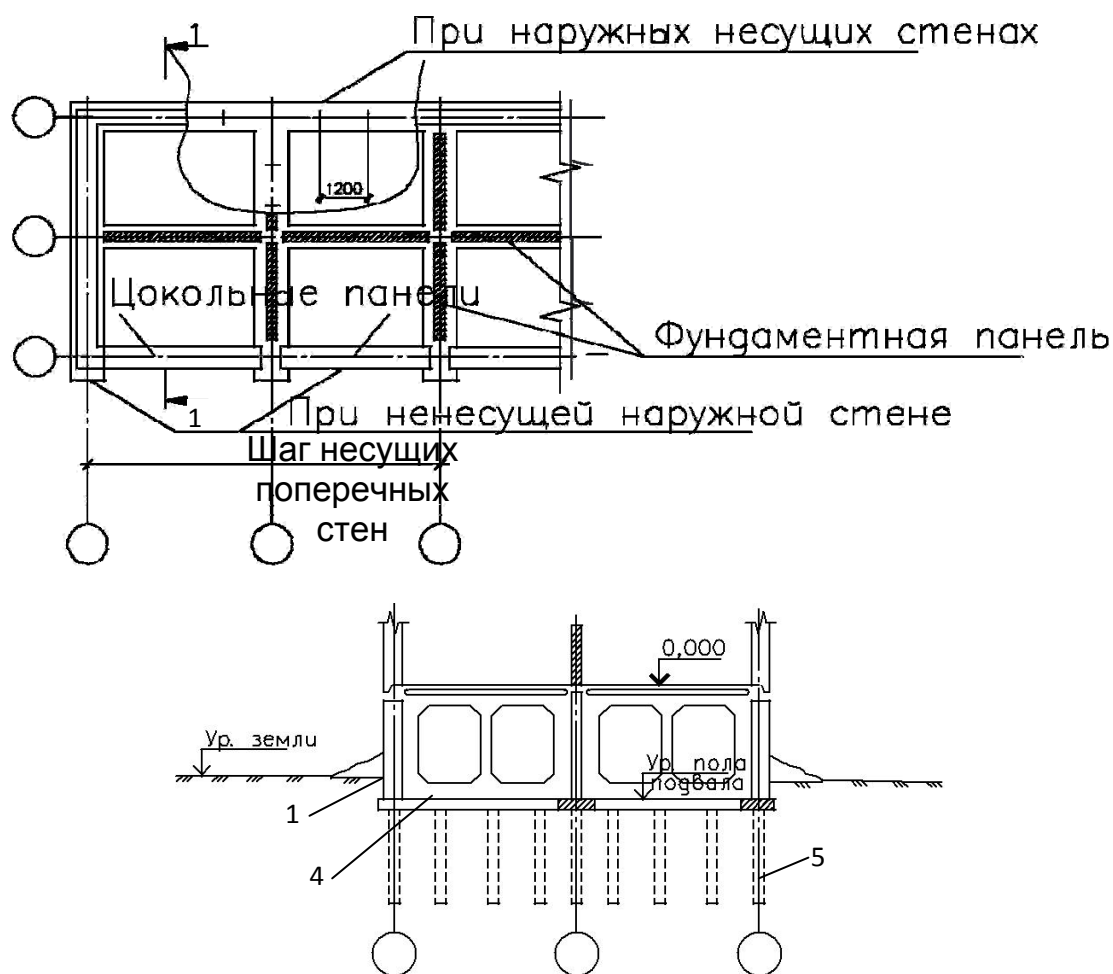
Схема фундаментов с монолитным низким ростверком
